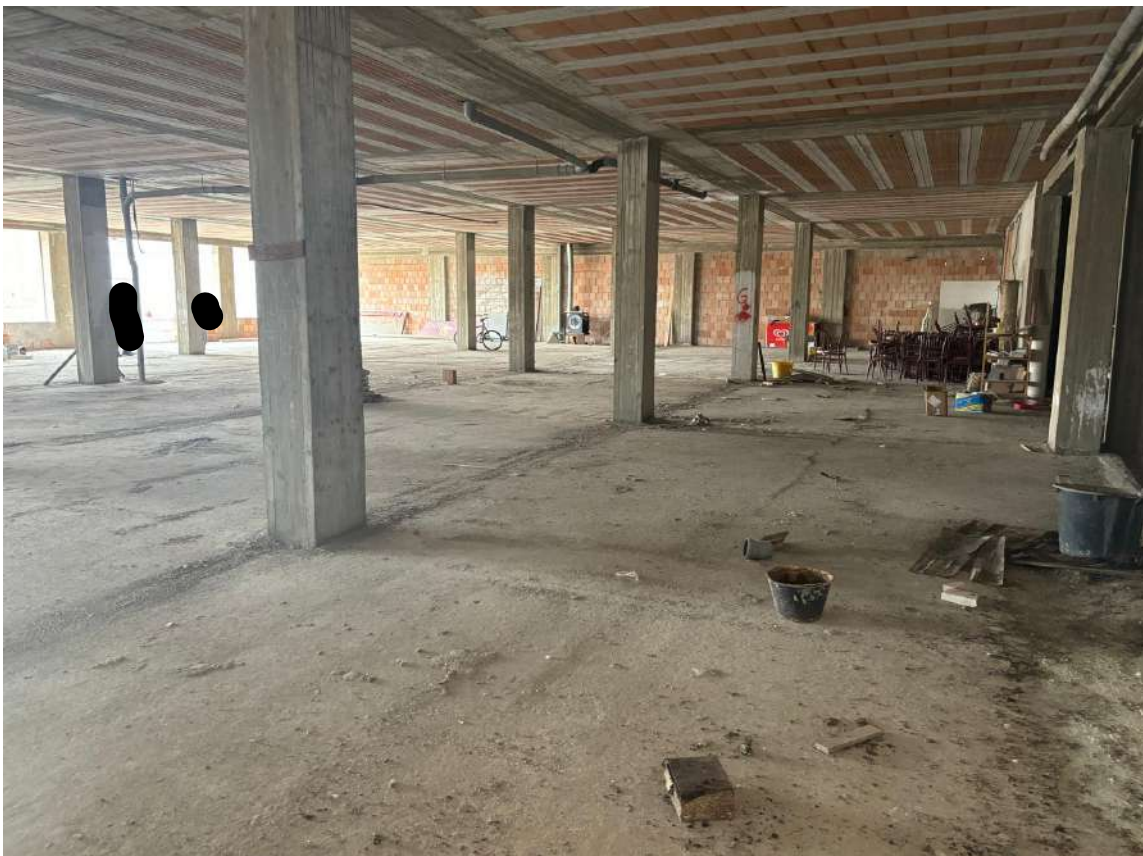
Vista dei locali dal sub 3, corridoio comune e sub 4 (in fondo)
